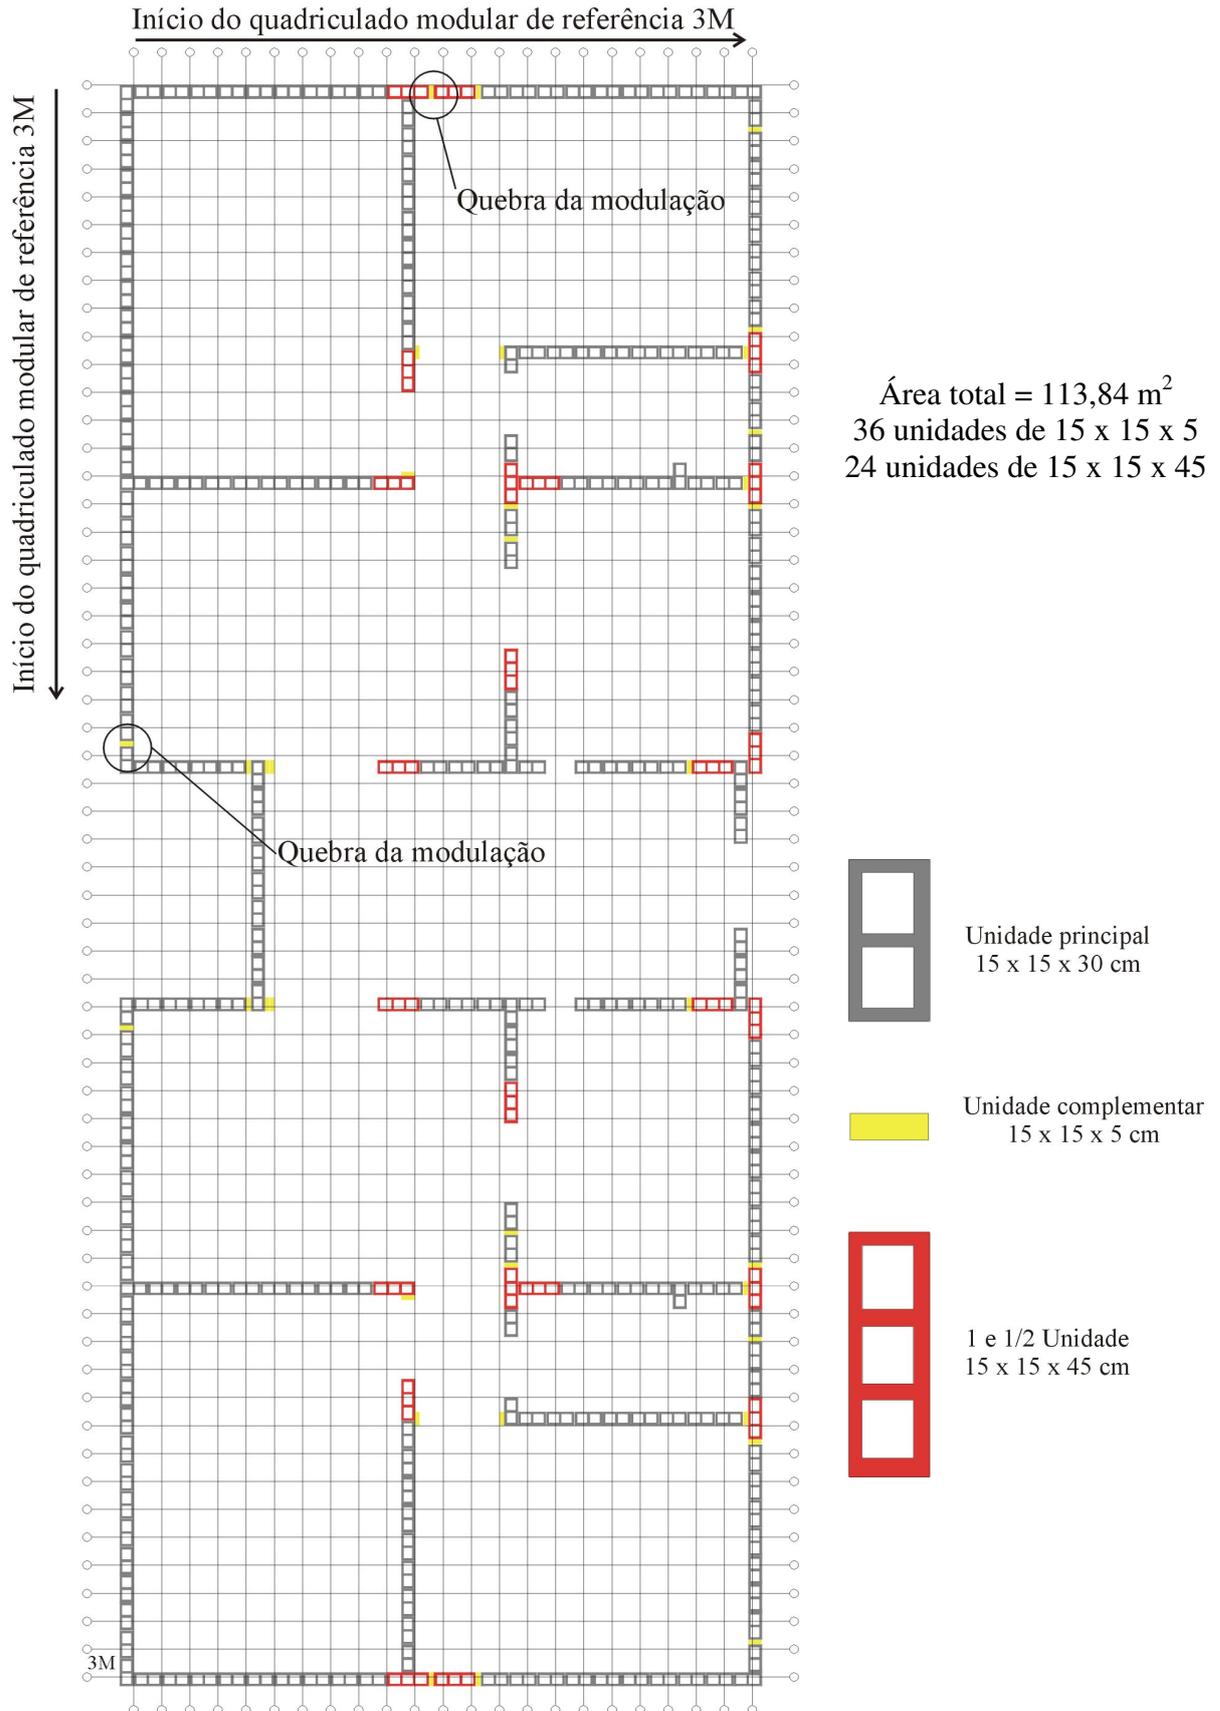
paginação da primeira fiada do pavimento tipo de um projeto de edifício multifamiliar adaptado de um projeto arquitetônico de um edifício em concreto armado para um projeto em alvenaria estrutural
